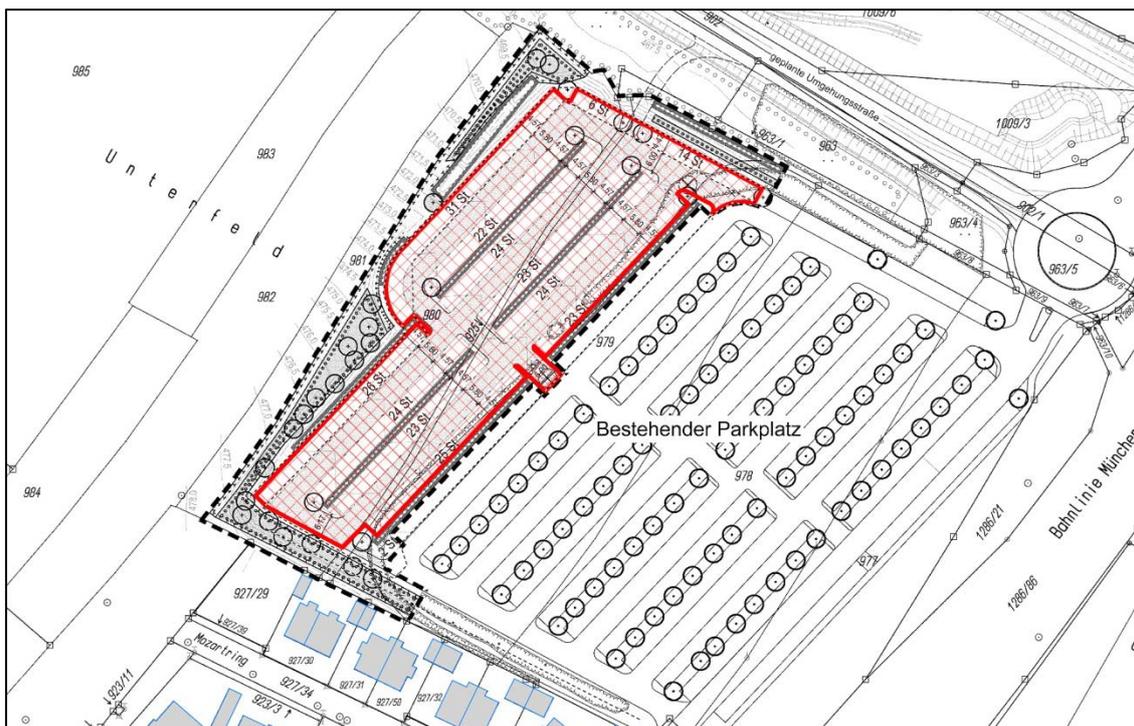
Lageplan mit Darstellung der relevanten Schallquellen
